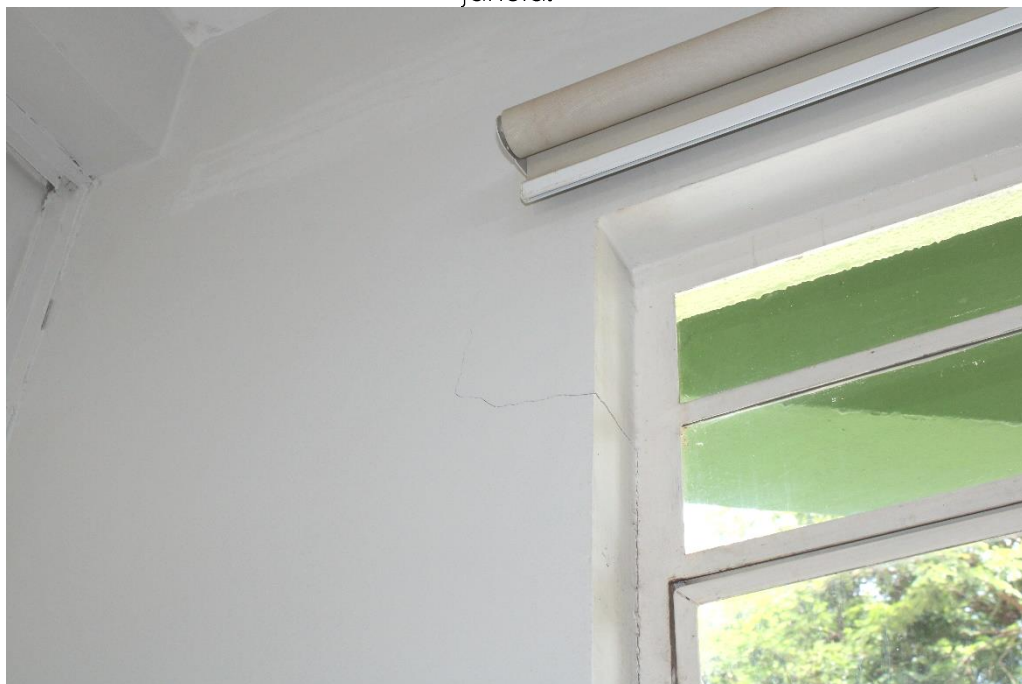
Em detalhe a foto acima, destacando fissura em alvenaria.
